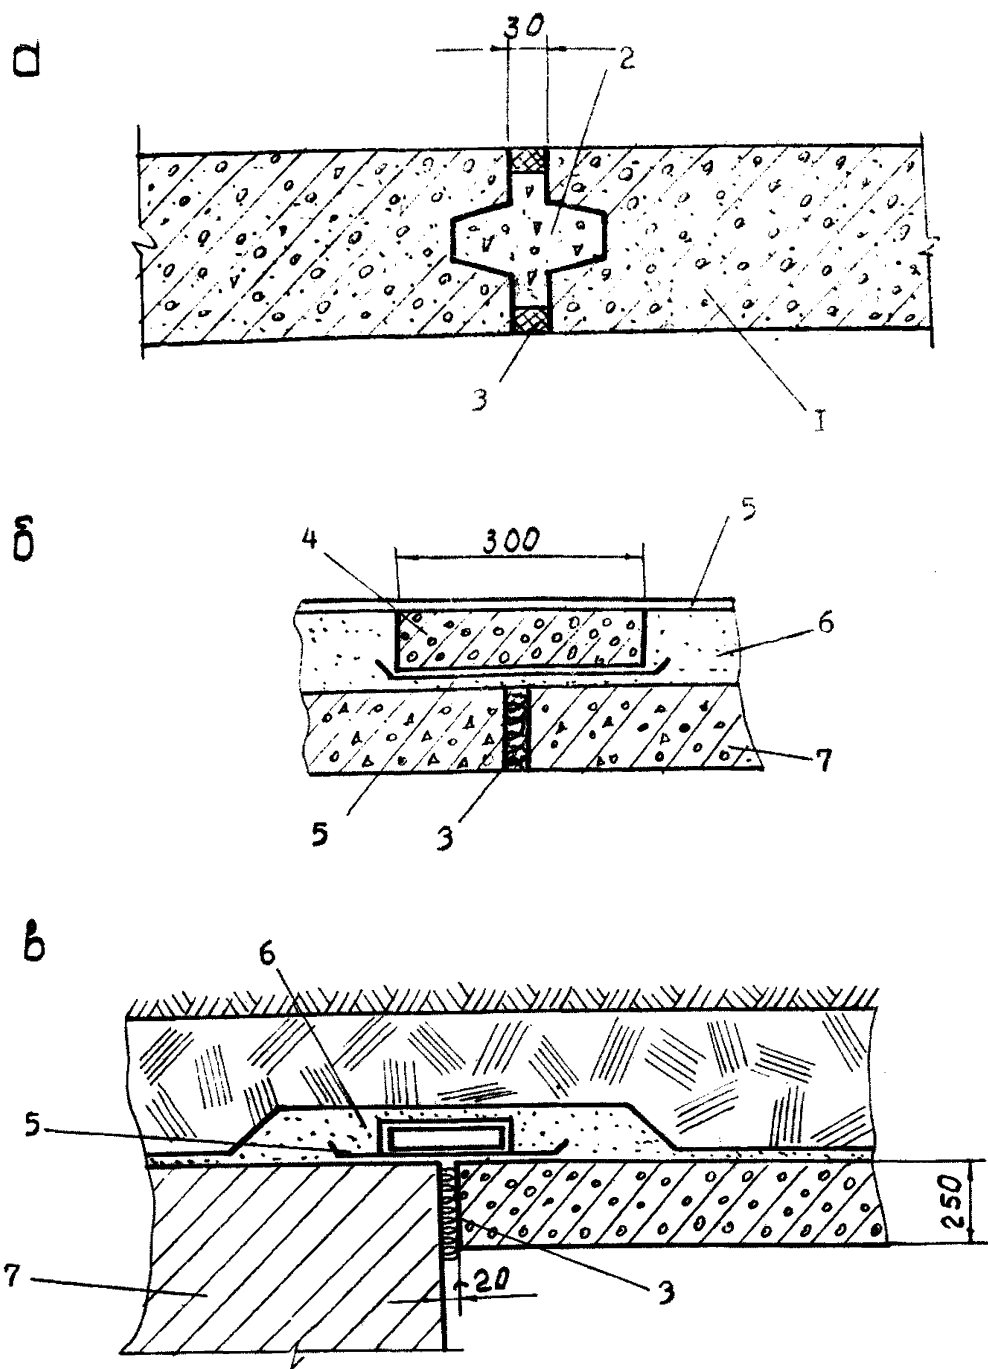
Герметизация стыков и швов в перекрытиях вентиляционных каналов:
